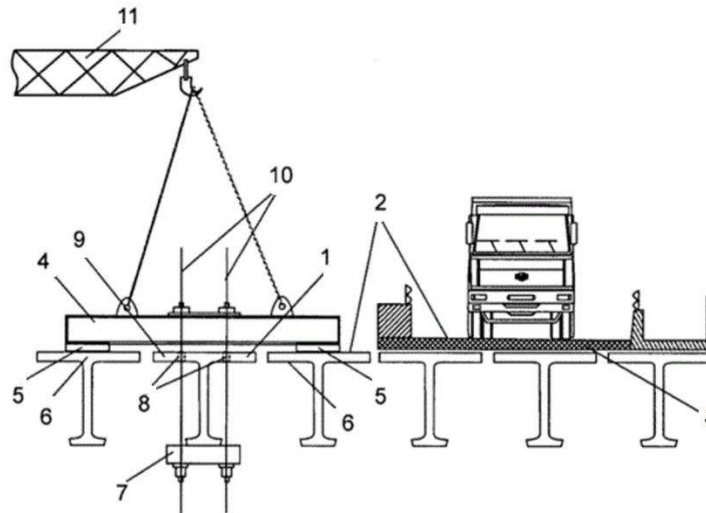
Спосіб демонтажу аварійної балки прогонової будови моста: 1 – аварійна балка; 2 – прогонова будова; 3 – тимчасове покриття; 4 – траверса; 5 – підкладки; 6 – сусідні балки; 7 – під траверса; 8 - стропувальні отвори; 9 – аварійна балка; 10 – тяги; 11 – підйомними кран [2]
